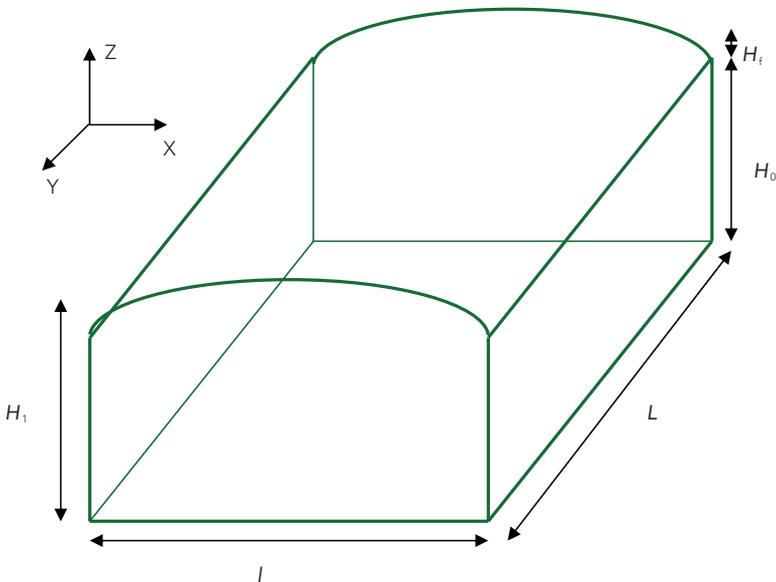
Exemple de bâtiment avec une toiture en forme de voûte.
